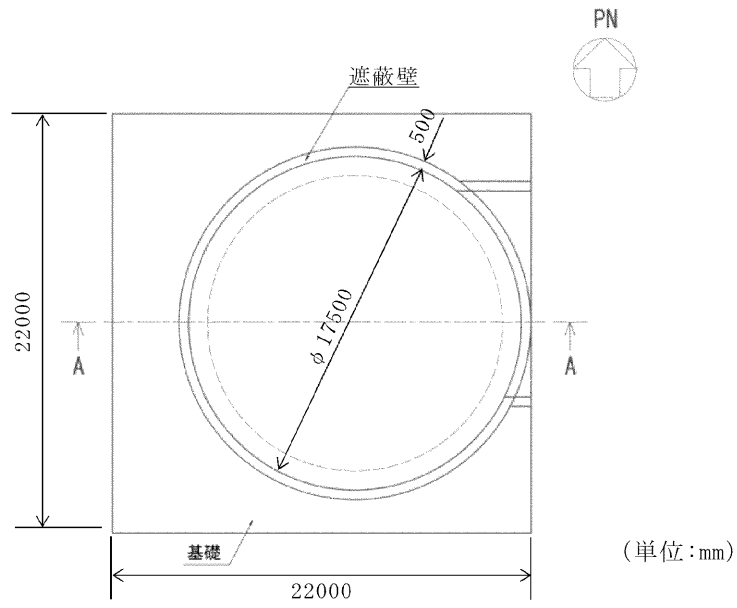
復水貯蔵タンク遮蔽壁 平面図
